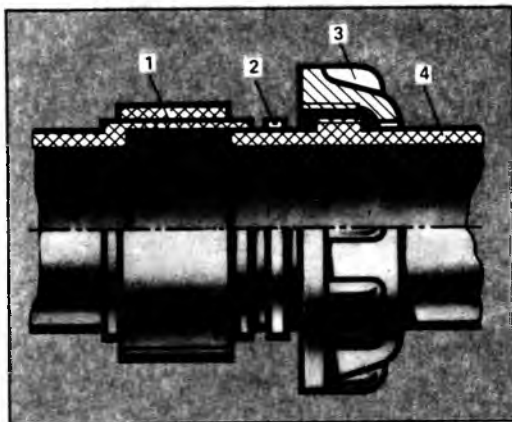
Разъемное соединение пластмассовых труб: 1 — труба с резьбой по раструбу, 2 — резиновая прокладка, 3 — пластмассовая накидная гайка, 4 — трубка с бутиком и центрирующим концом
